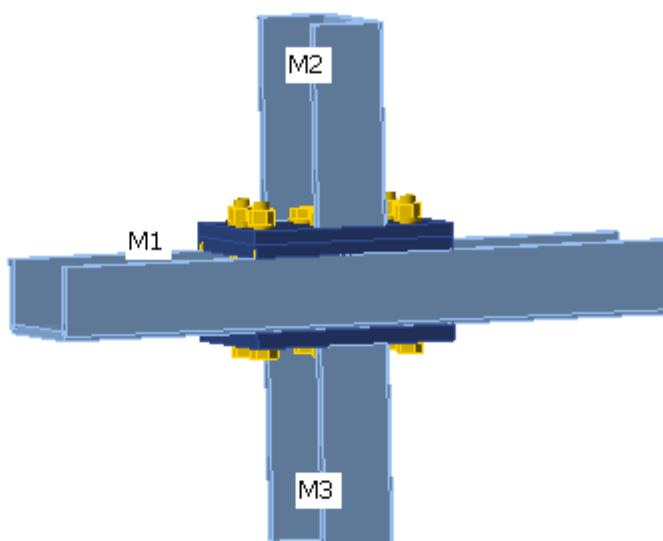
Connessione pilastro parapetto – Output Idea statica.
